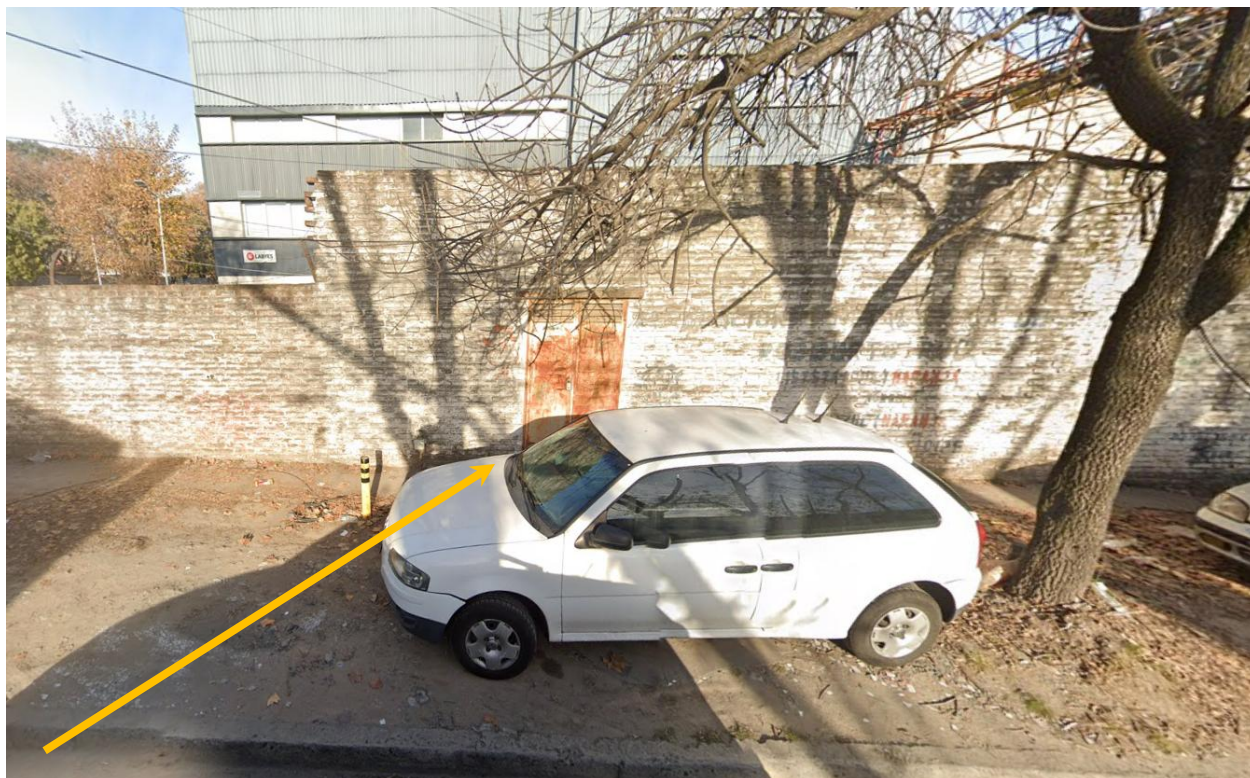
Vista en detalle del sector donde se construiría el nuevo edificio de la ERP Haedo II. Se observa la garita de gas existente.
